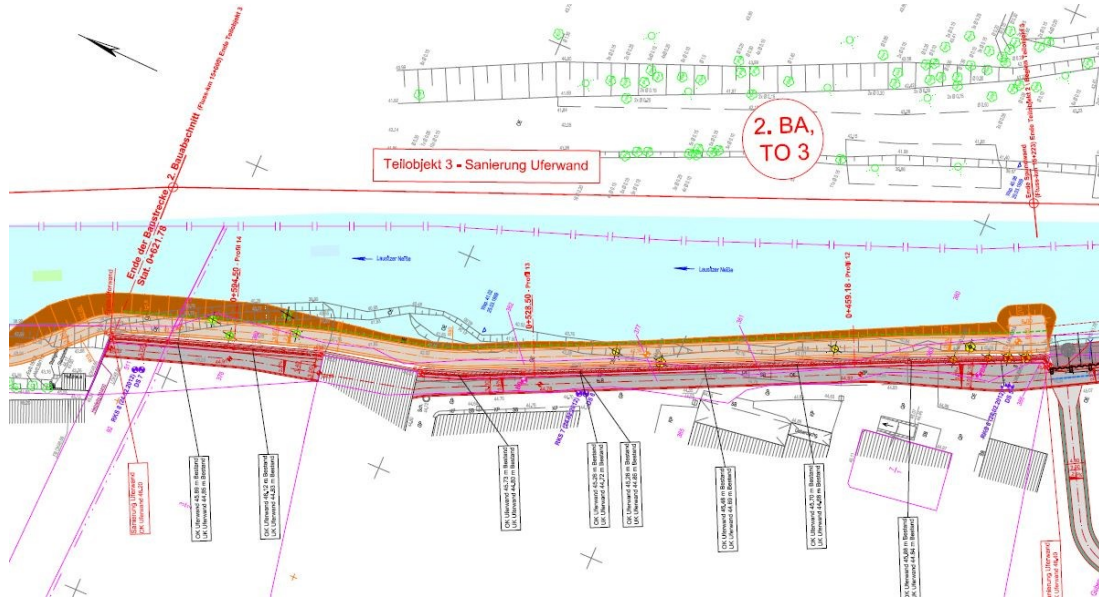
Übersichtslageplan HWS Guben, 2. BA , TO 3
